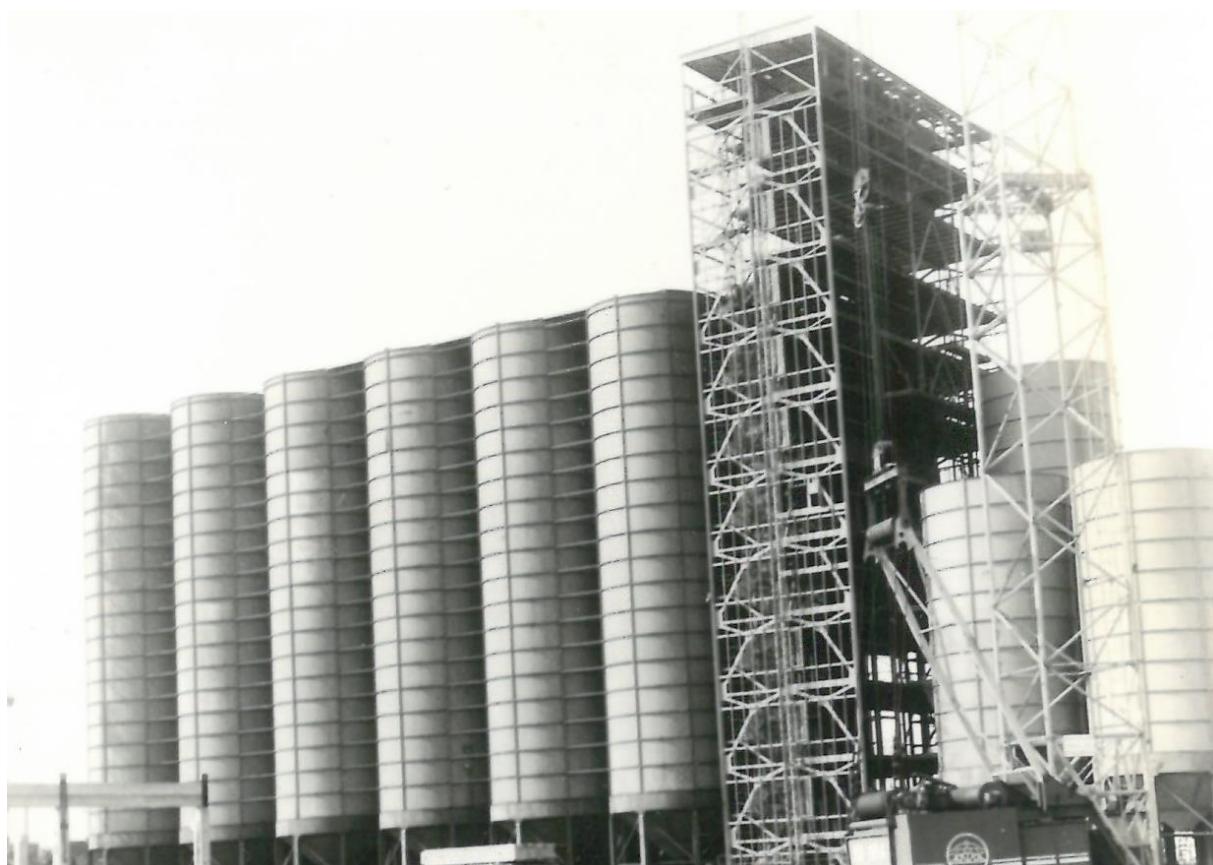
Betonové silo 21kt, Kolín 1968
